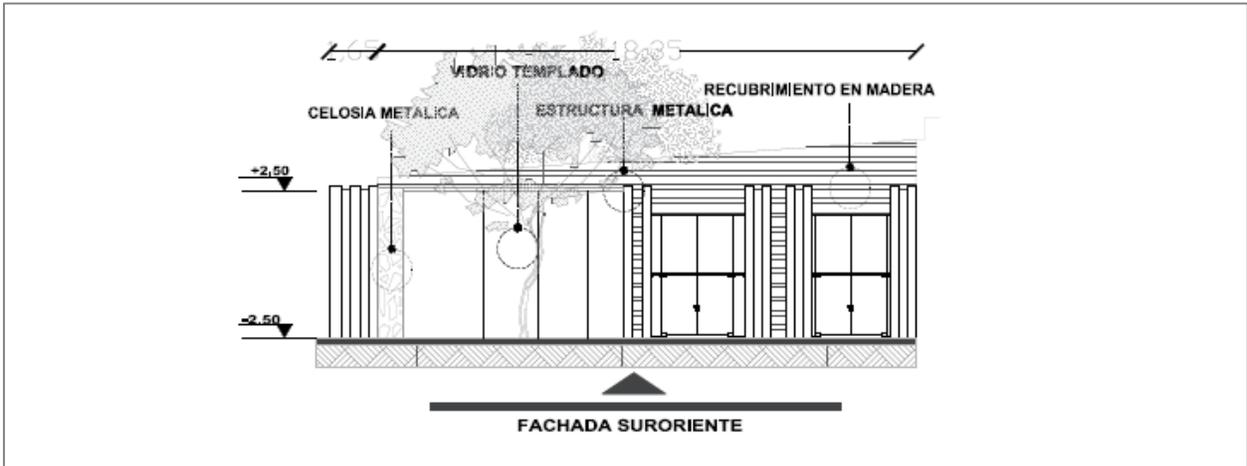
Fachada Suroriente Edificio 4 (Rubiano, 2020)
